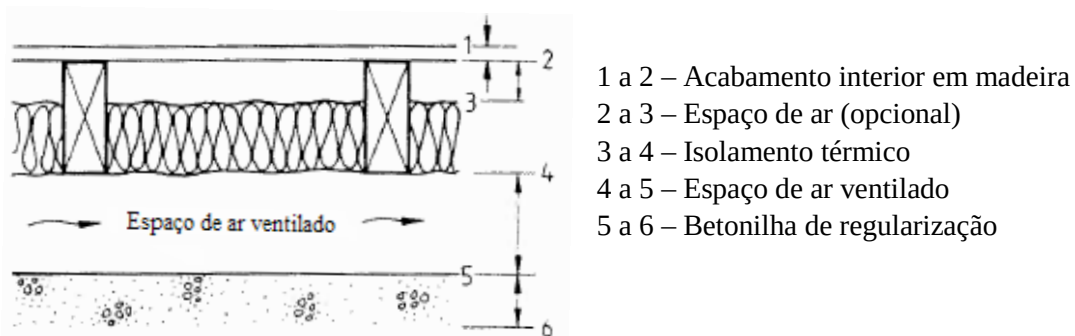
Constituição de pavimentos sobre desvão sanitário em madeira com estrutura de suporte descontínua [2]
